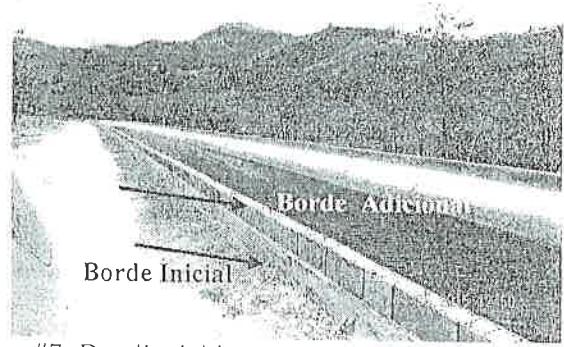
Detalle del levantamiento del borde del canal de conducción.
